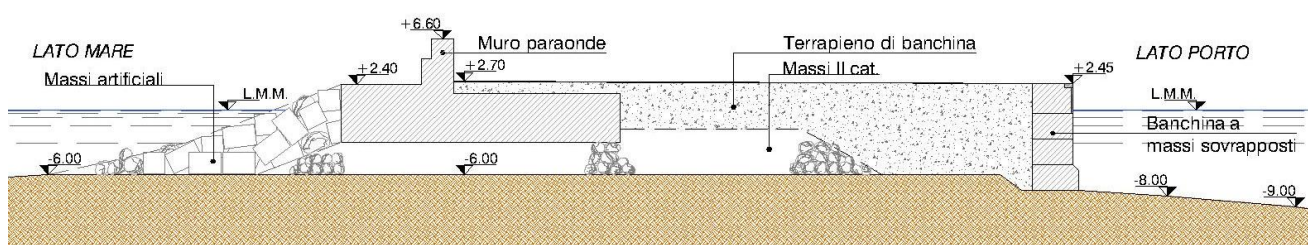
Sezione tipo dell'antemurale Traiano in corrispondenza della banchina Marconi
